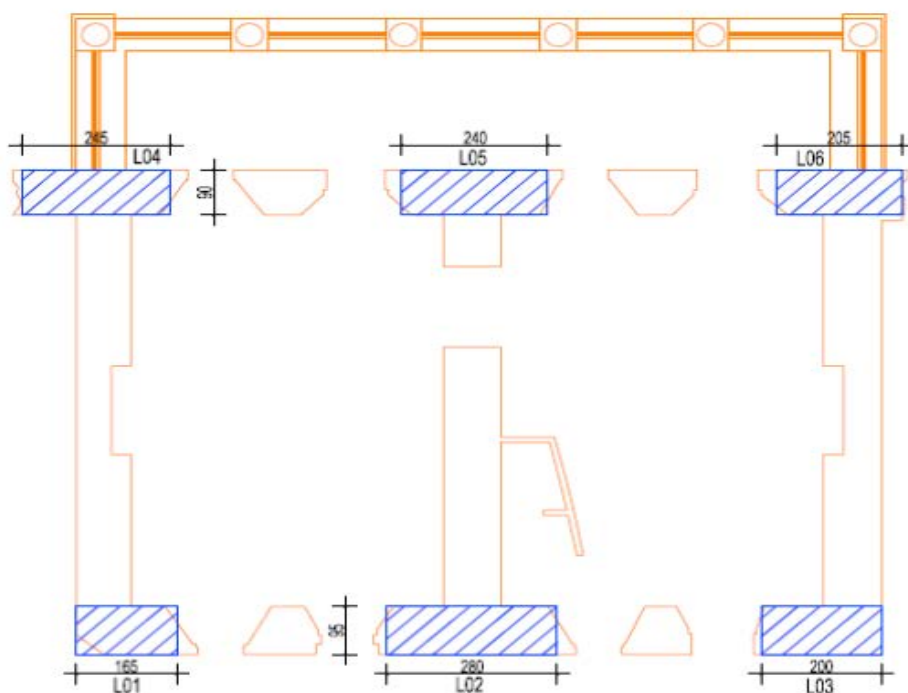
Dispunerea elementelor structurale – șpaleti din zidărie pe direcție longitudinală
